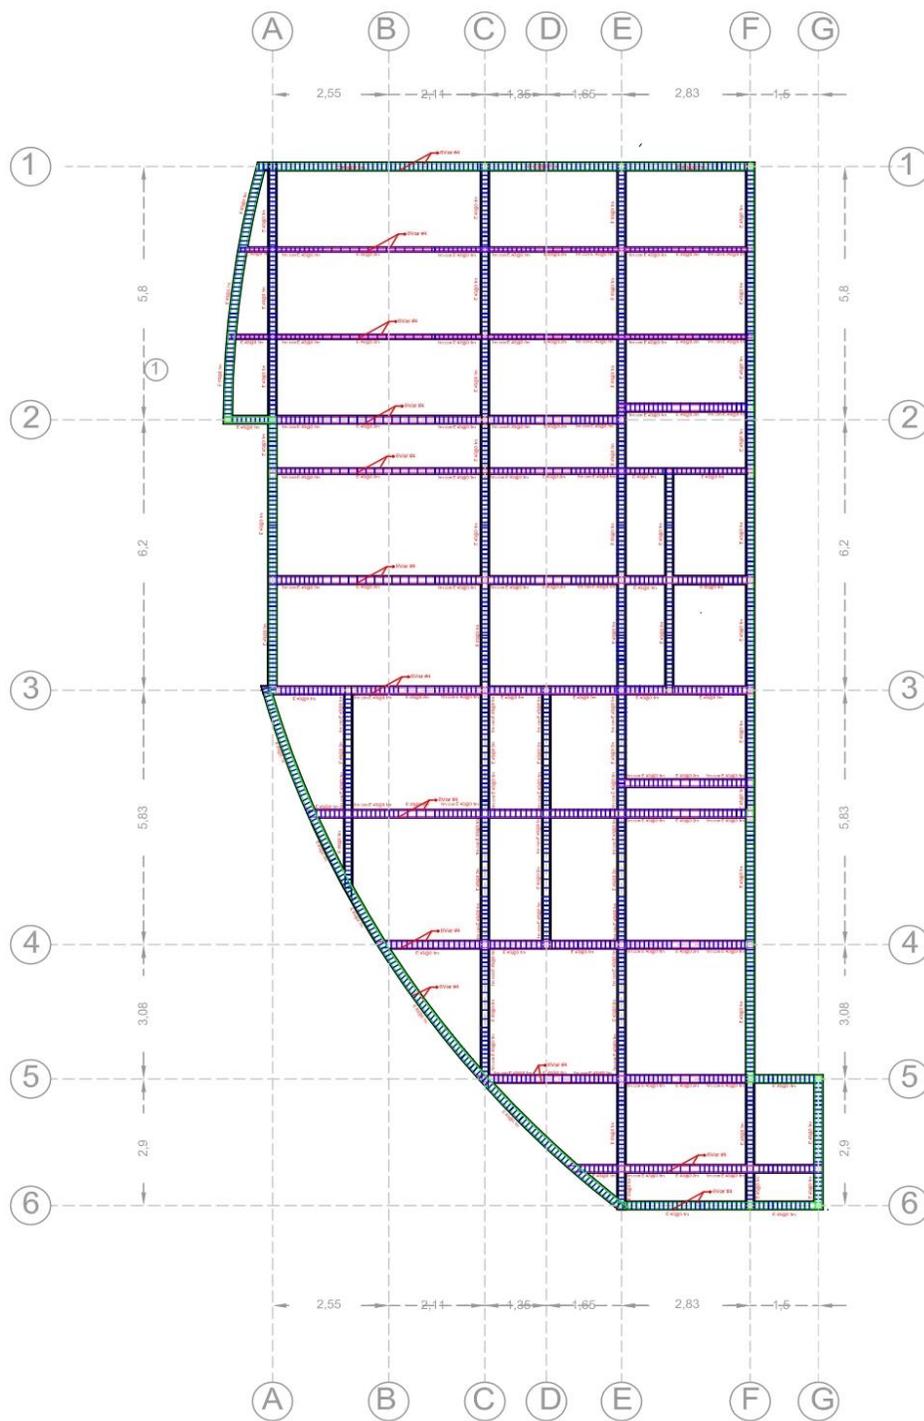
Despiece vigas aéreas entrepiso y cubierta
